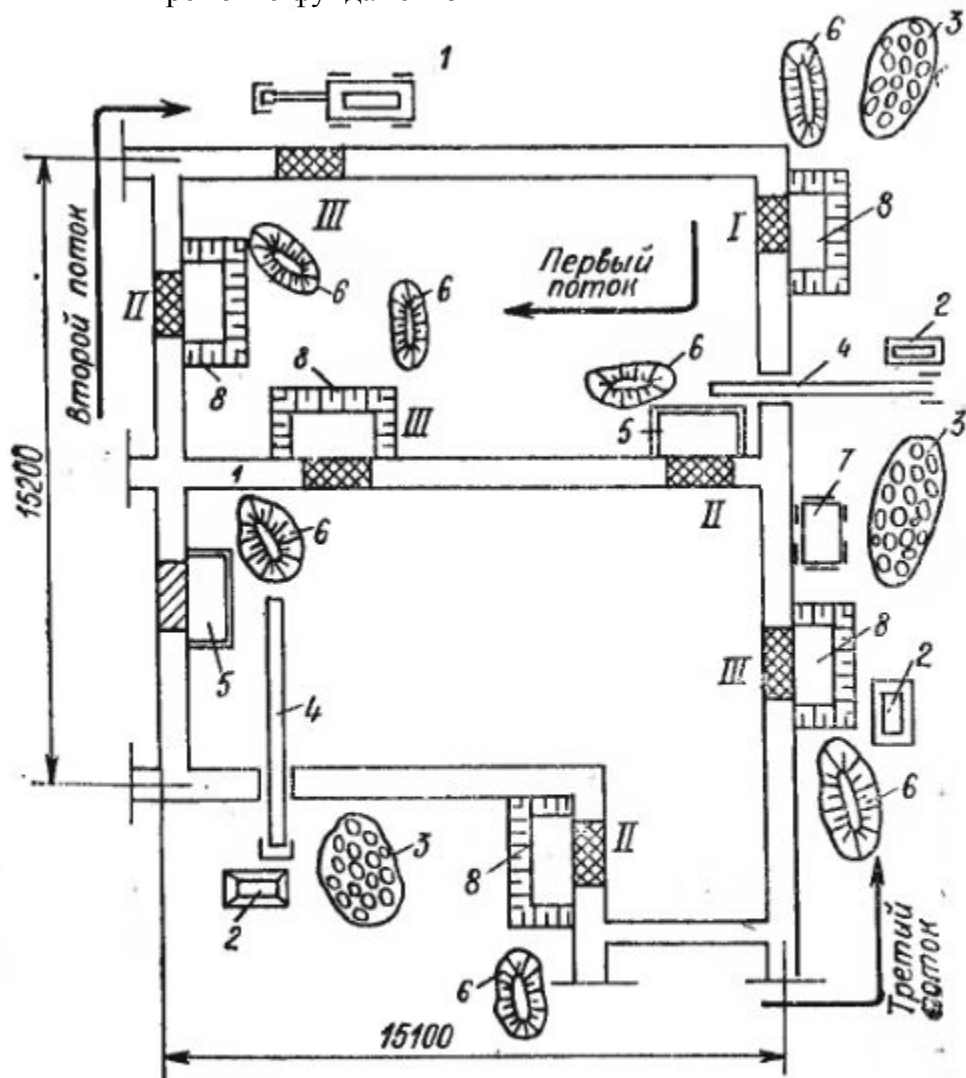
Схема организации работ по перекладке отдельных участков фундаментов
